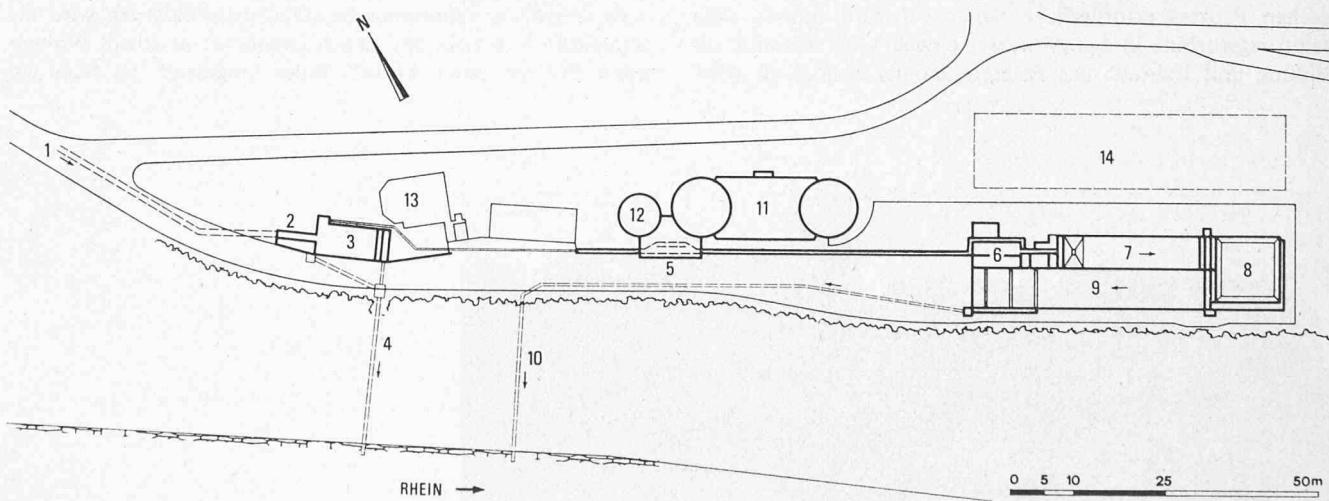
Lageplan der Abwasserreinigungsanlage Uhwiesen-Dachsen
